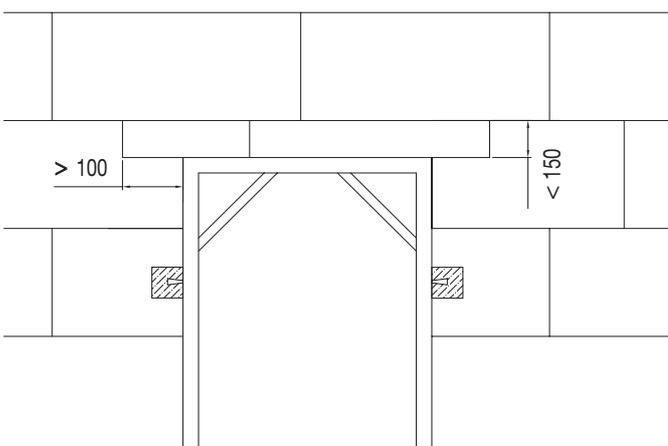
Tira de pieza LADRYESO 6® que rebasa lateralmente la carpintería
